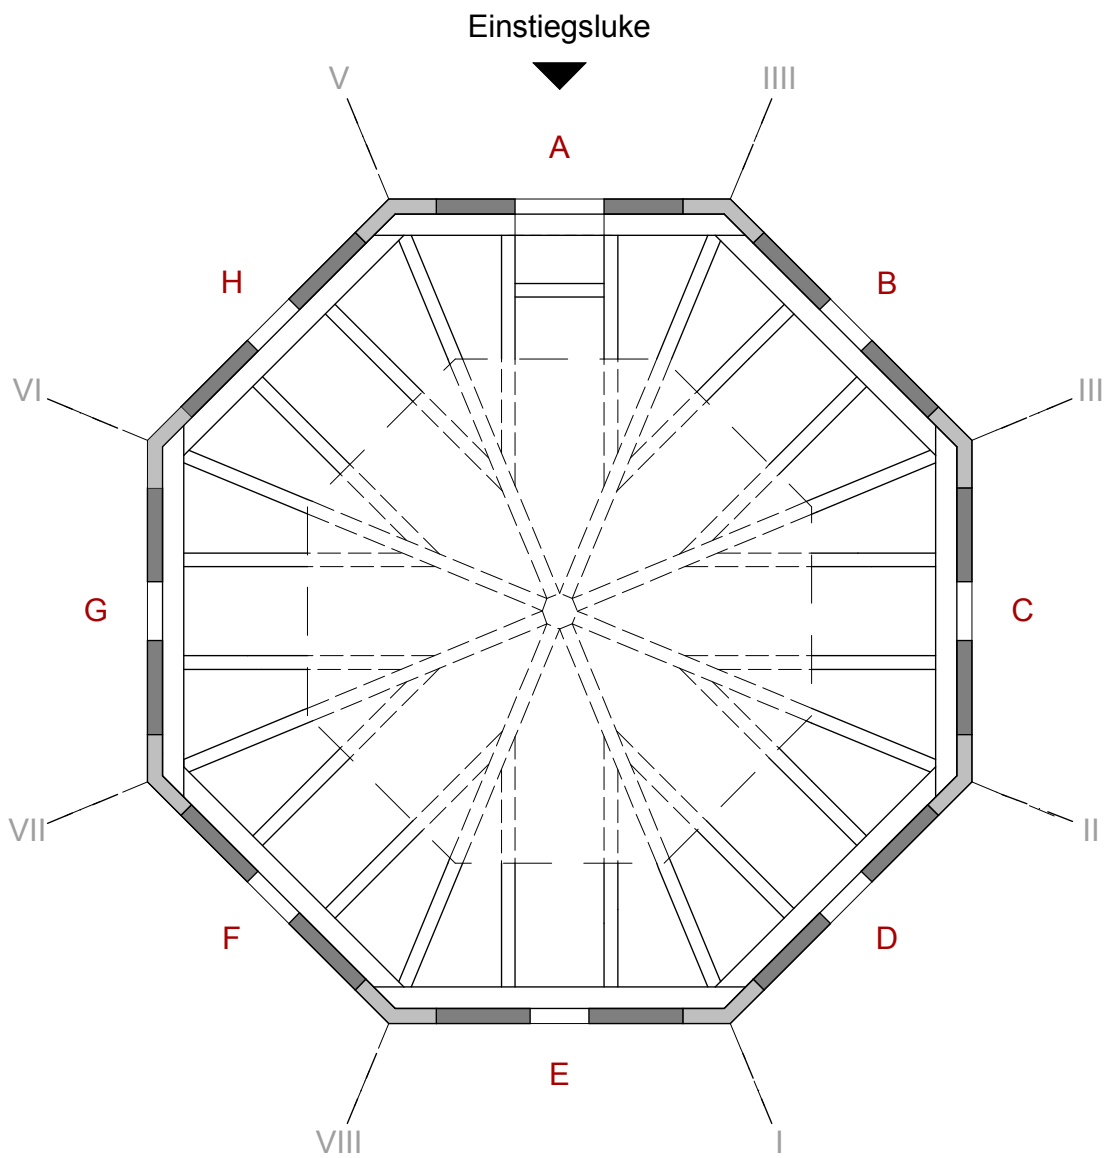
Übersichtsgrundriss (Skizze) des Dachgeschosses, M 1:100.
